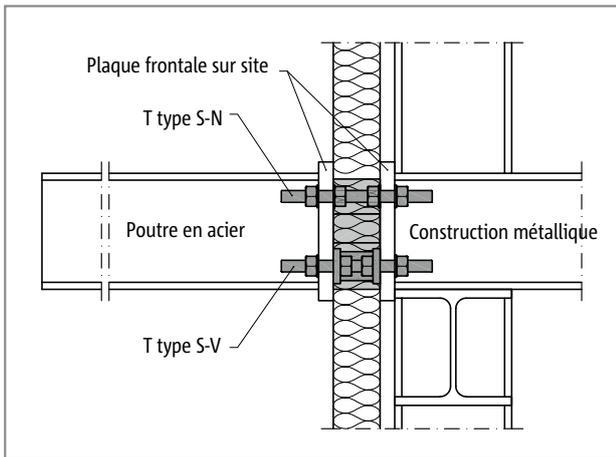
Schöck Isokorb® T type S-N et T type S-V : construction en acier en porte-à-faux libre
